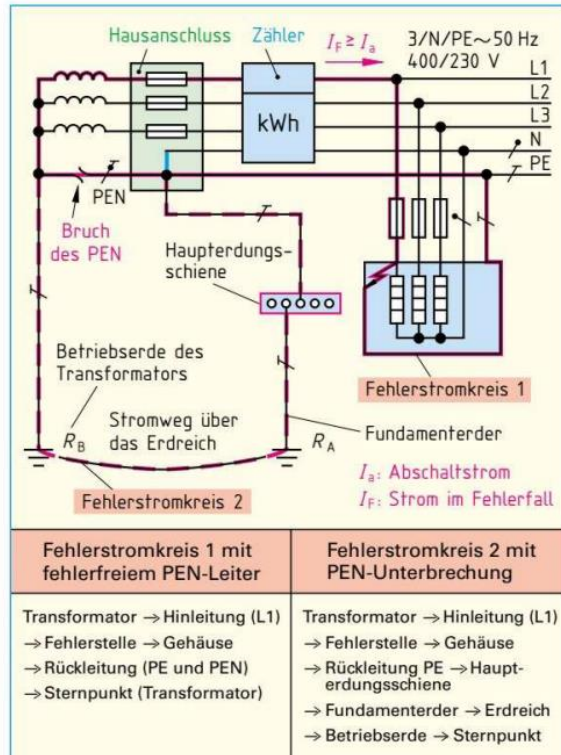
Schutz durch Erdung im TN-C-S-System bei einem Körperschluss
